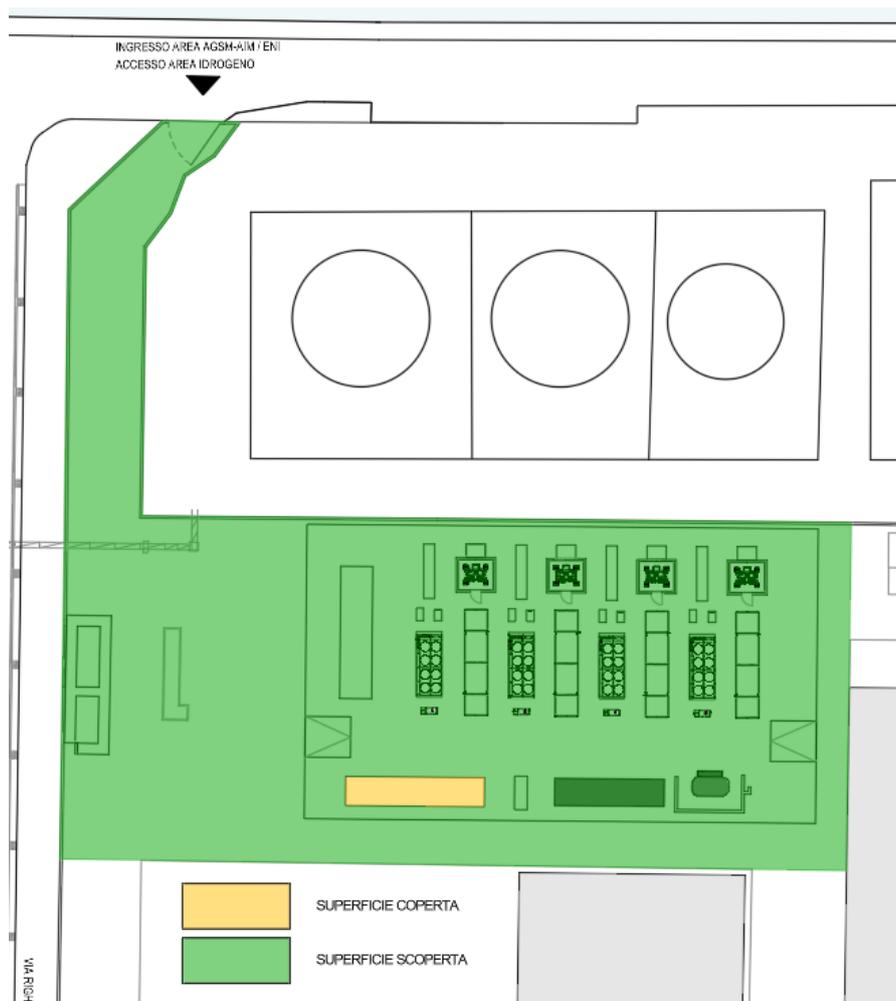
Planimetria con evidenza di superfici coperte e scoperte
